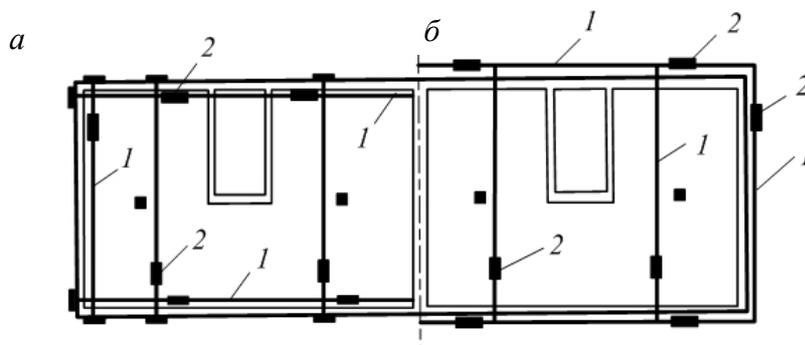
Усиление стальными напрягаемыми тязями: *a* – расположение тязей внутри здания; *б* – расположение тязей снаружи здания;
